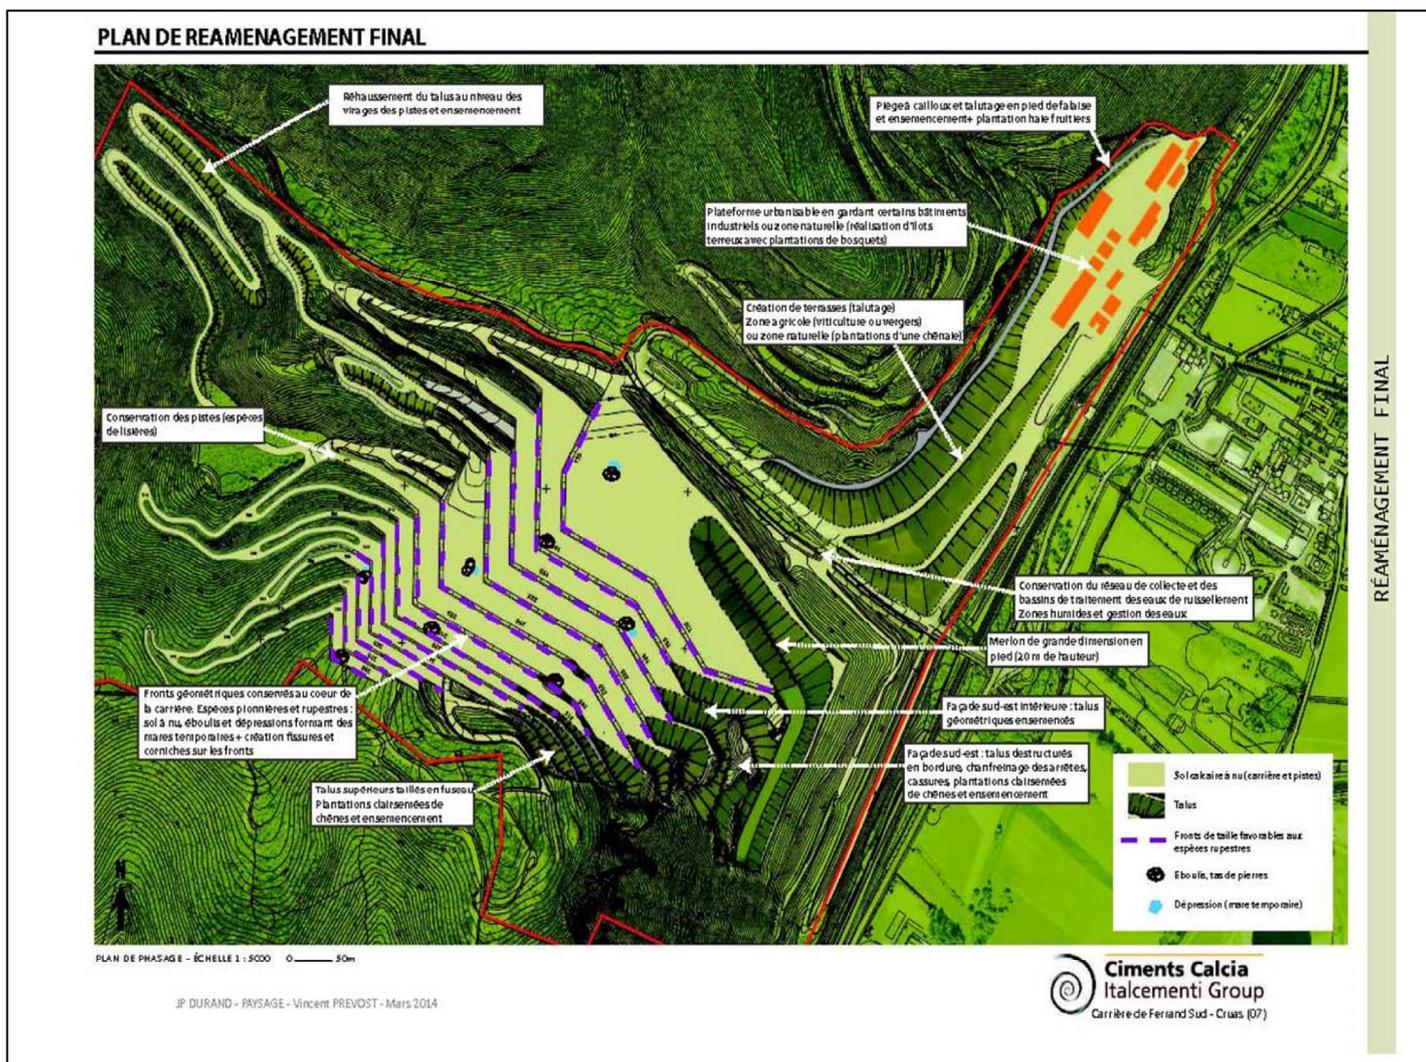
Plan de réaménagement final de la carrière (source : CIMENTS CALCIA)
